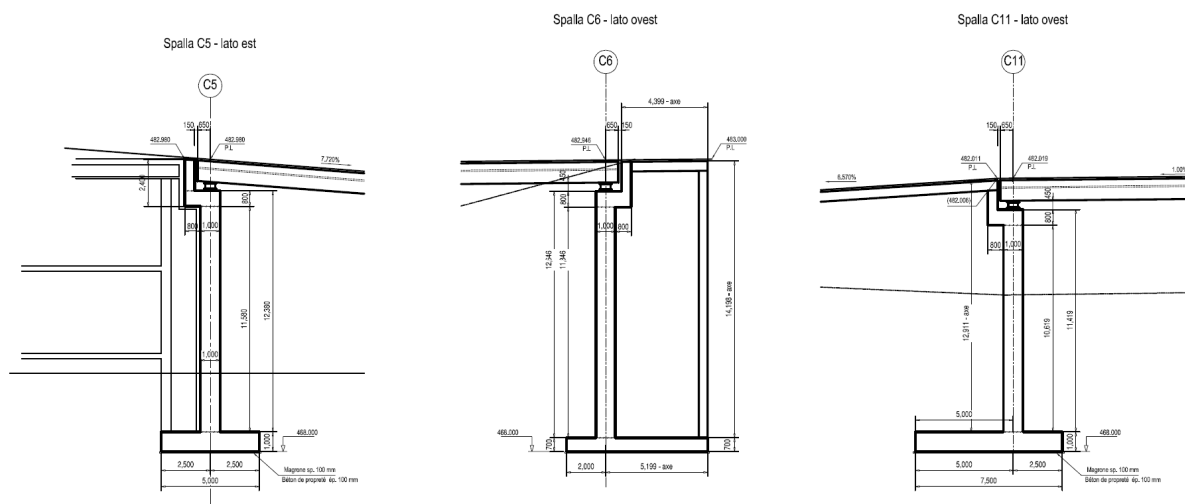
spalla C5, lato est e spalle C6 e C11, lato ovest – carpenterie.
